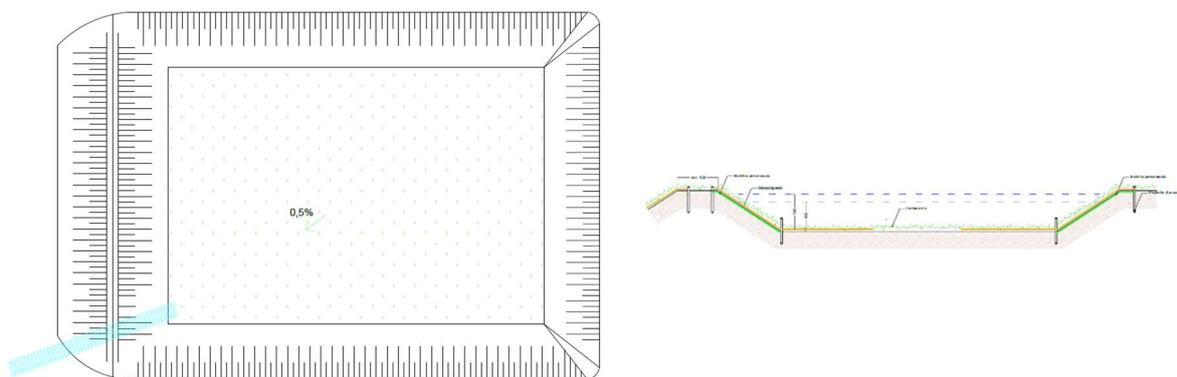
Sezione e pianta tipo di trincea e laghetto di laminazione
